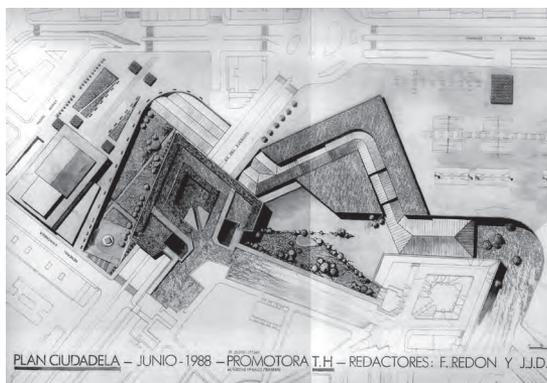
Planta de cubiertas del Plan Ciudadela, F. Redón y J.J.D. Yarza, Junio 1988.
